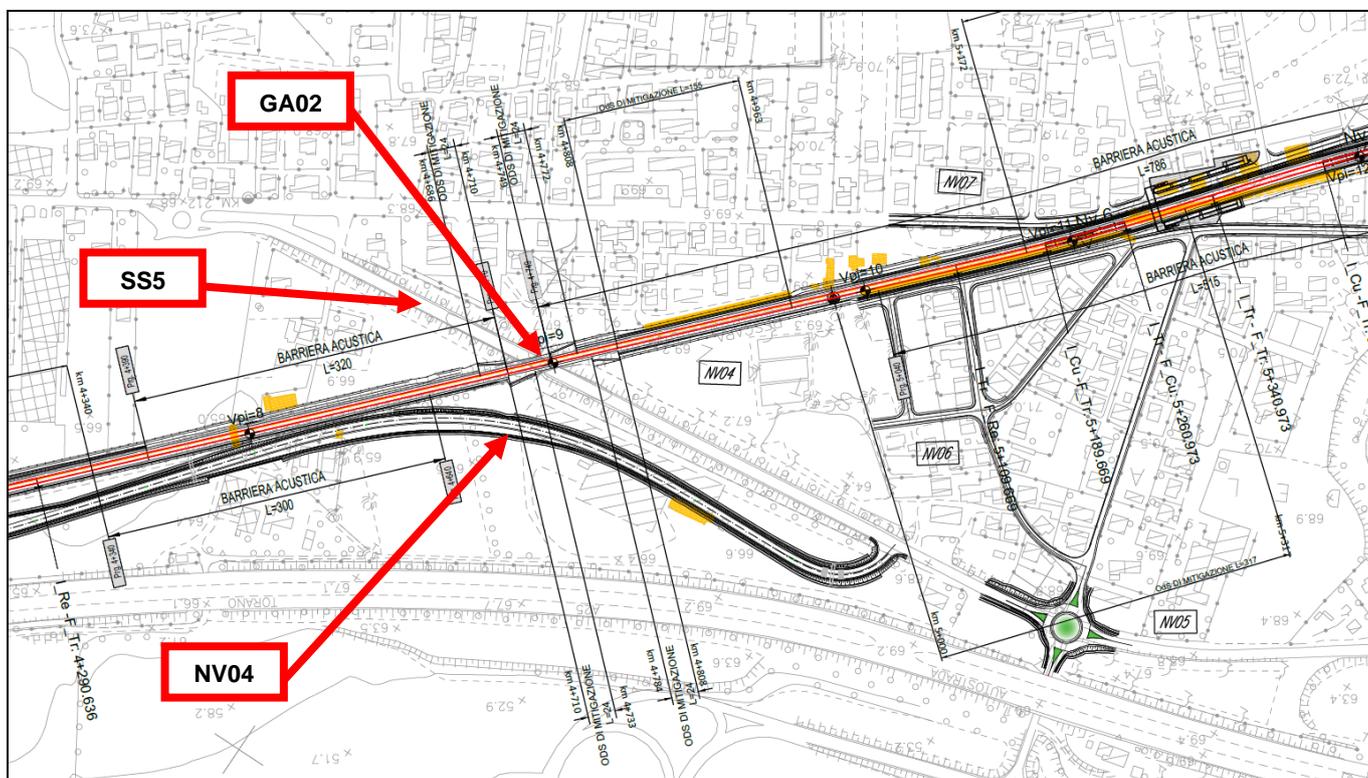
Stralcio planimetrico raddoppio di sede al km 4+739,970
